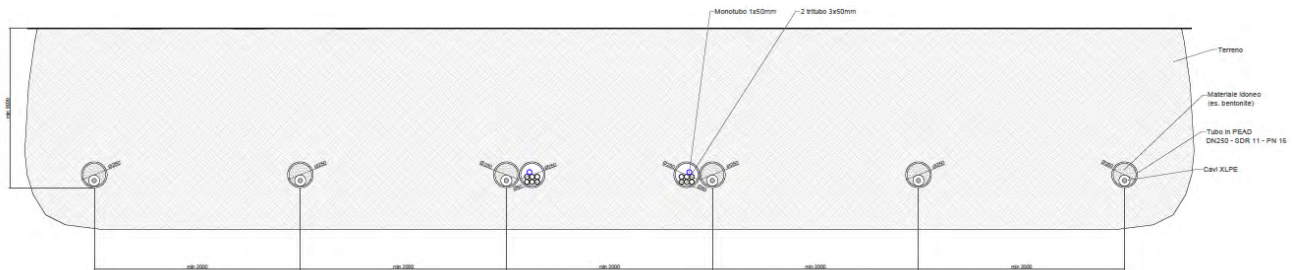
Cavo 380 kV – Posa in TOC – Sezione tipo “C” – Perforazione Orizzontale Controllata. Estratto elaborato KAI.ENG.TAV.0.58.00_Tipologici di posa cavidotto – Planimetria e sezioni – Tav. 2/3.
